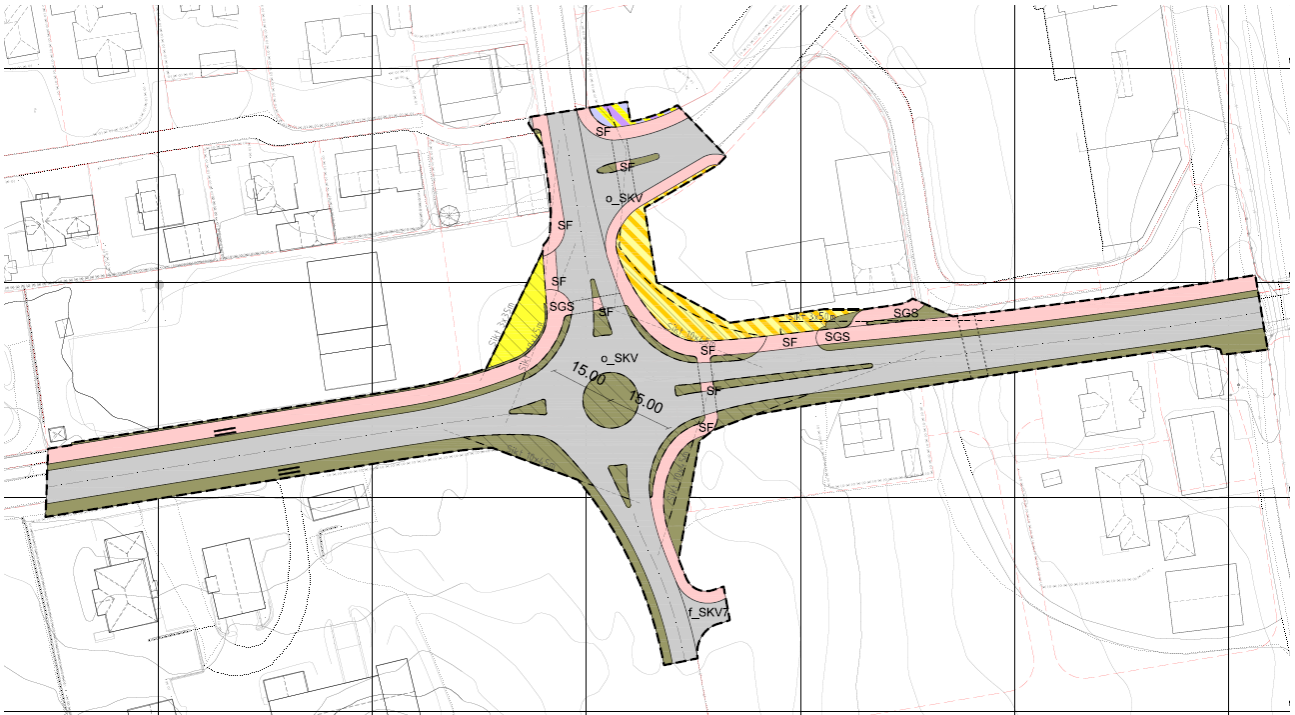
Ny plassering av rundkjøring vist i den nåværende planen.
